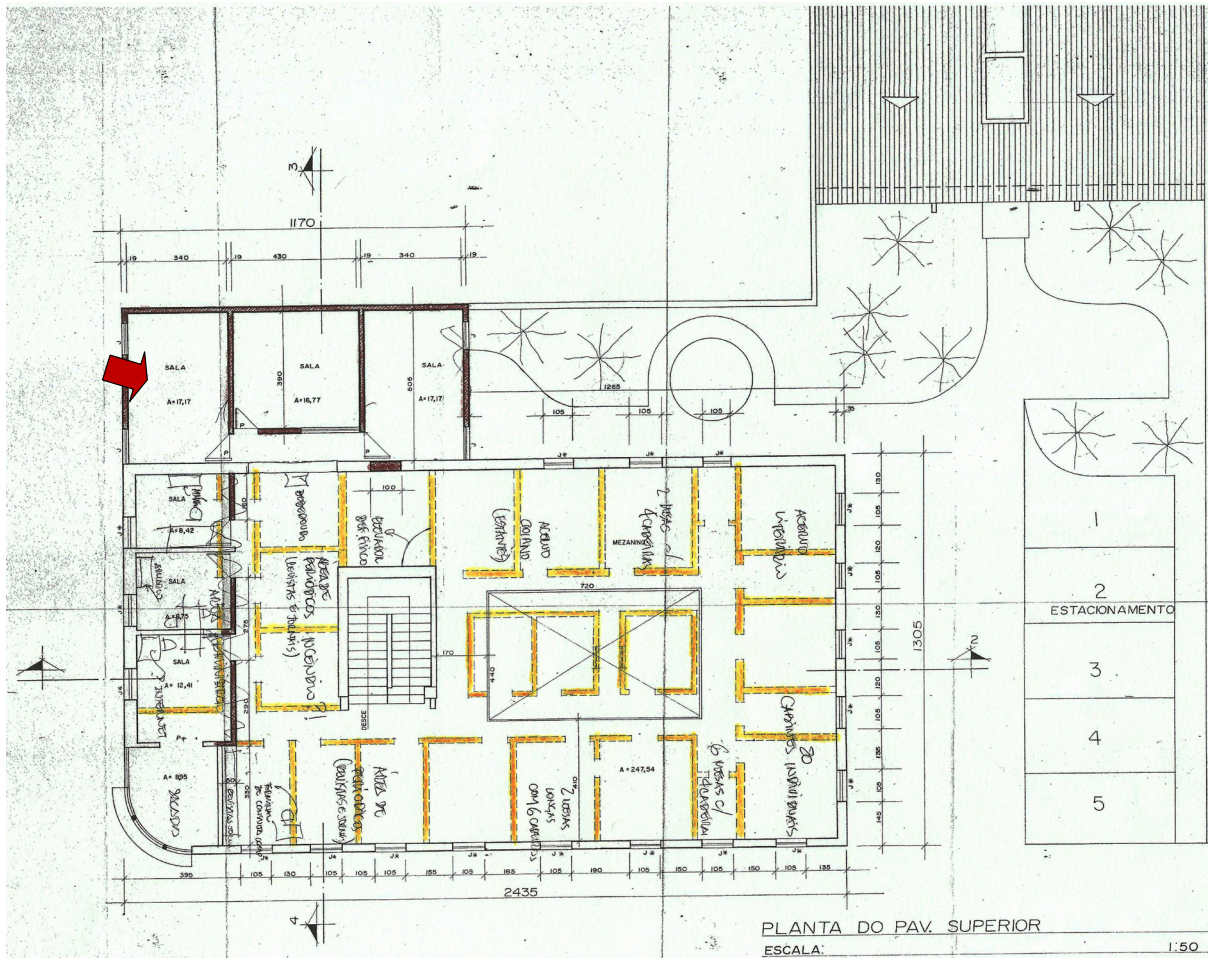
Planta da Reforma do Pavimento Superior do Palace Hotel de Campinas.
